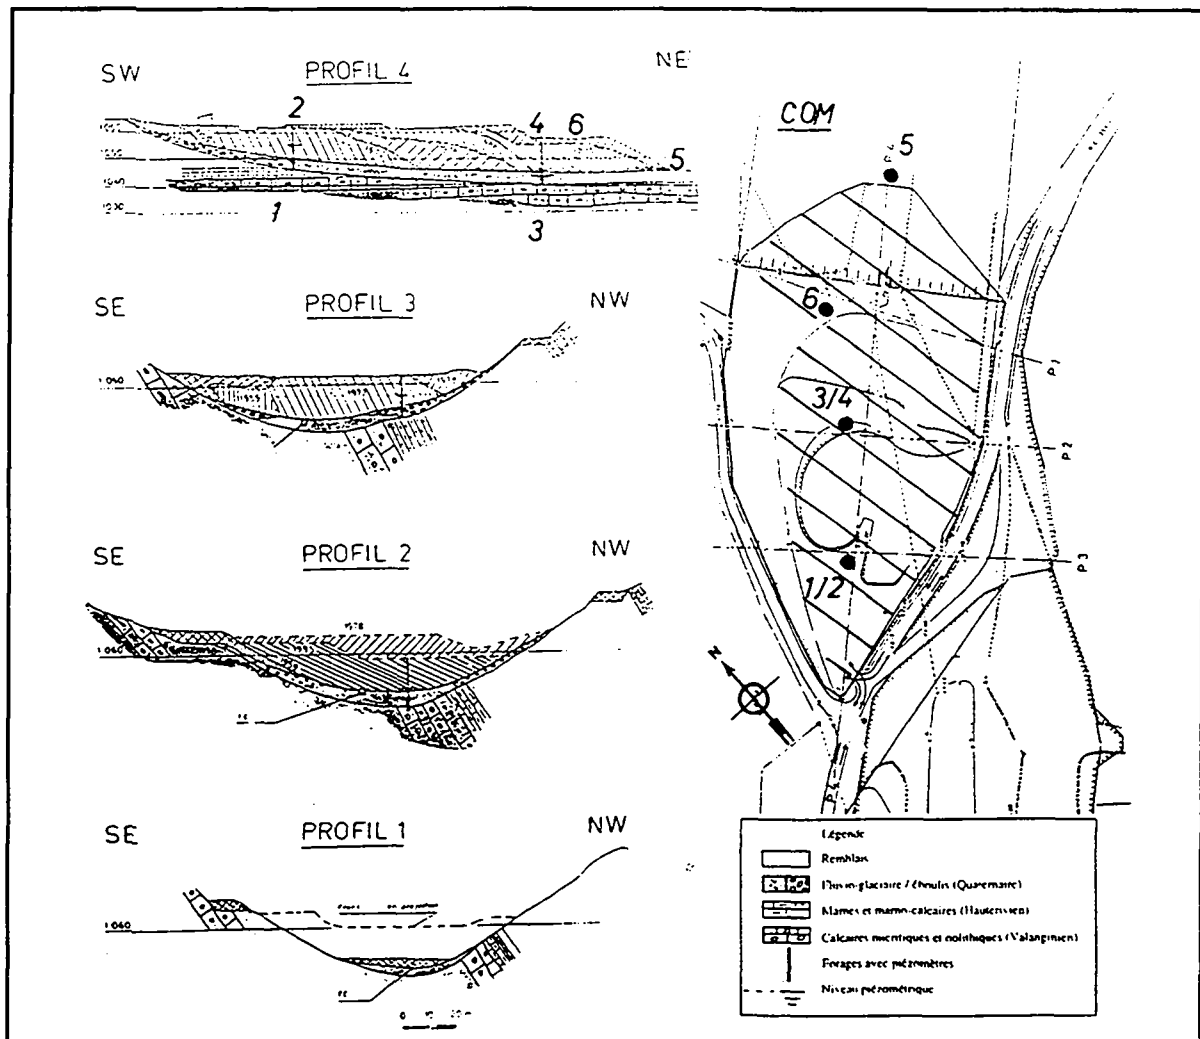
Plan du site de COM, et coupes à travers le site.
